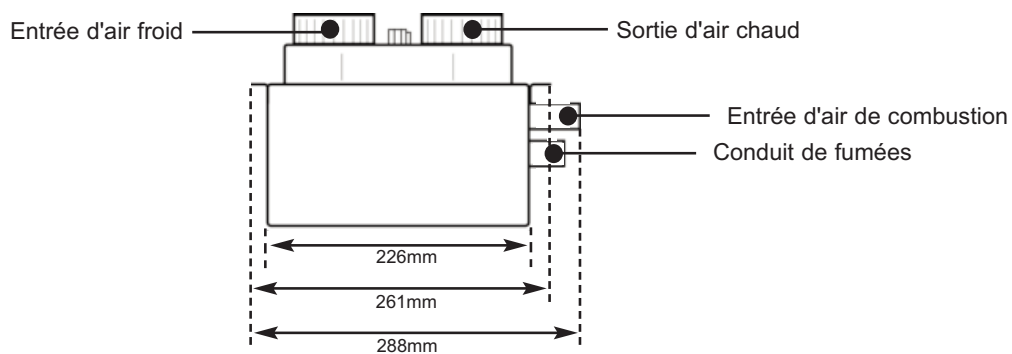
Installation sous plancher - Vue frontale - SH2211 ou SC2211
